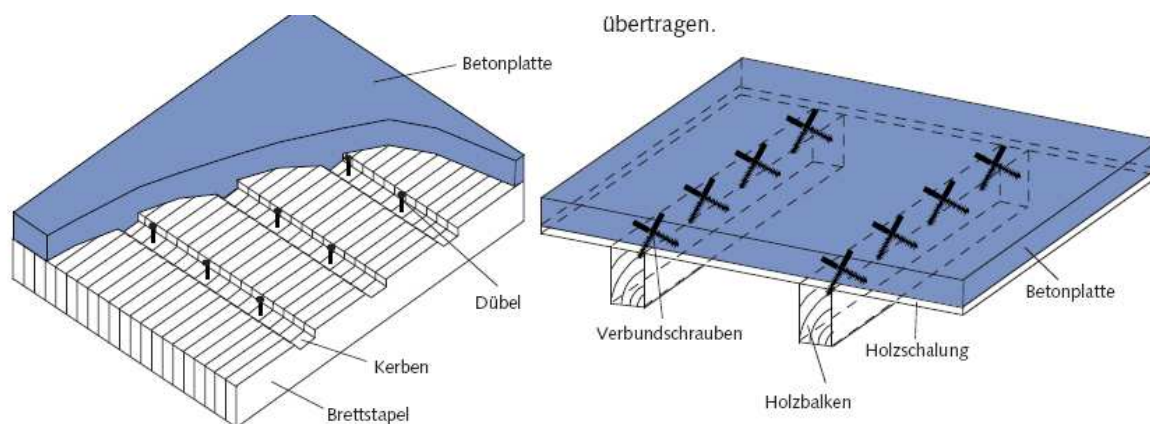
Übersicht Holz-Beton-Verbunddecke mit Träger bzw. Platte aus Holz [4]
